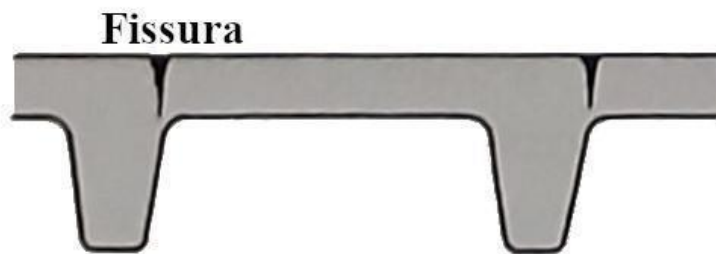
Representação de uma fissura no pilar causada por assentamento plástico
